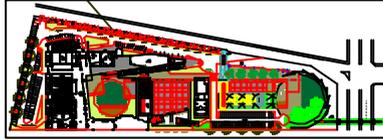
Planta - Proyecto del Centro de Convenciones y Exposiciones De Popayán.
